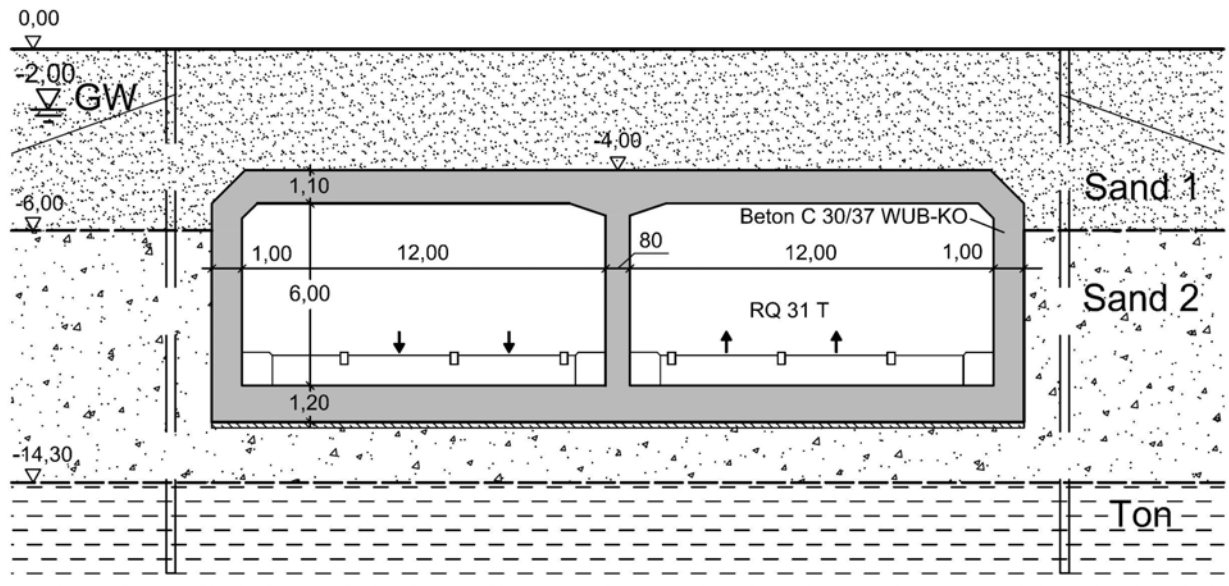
Tunnel in offener Bauweise, Querschnitt Endzustand
